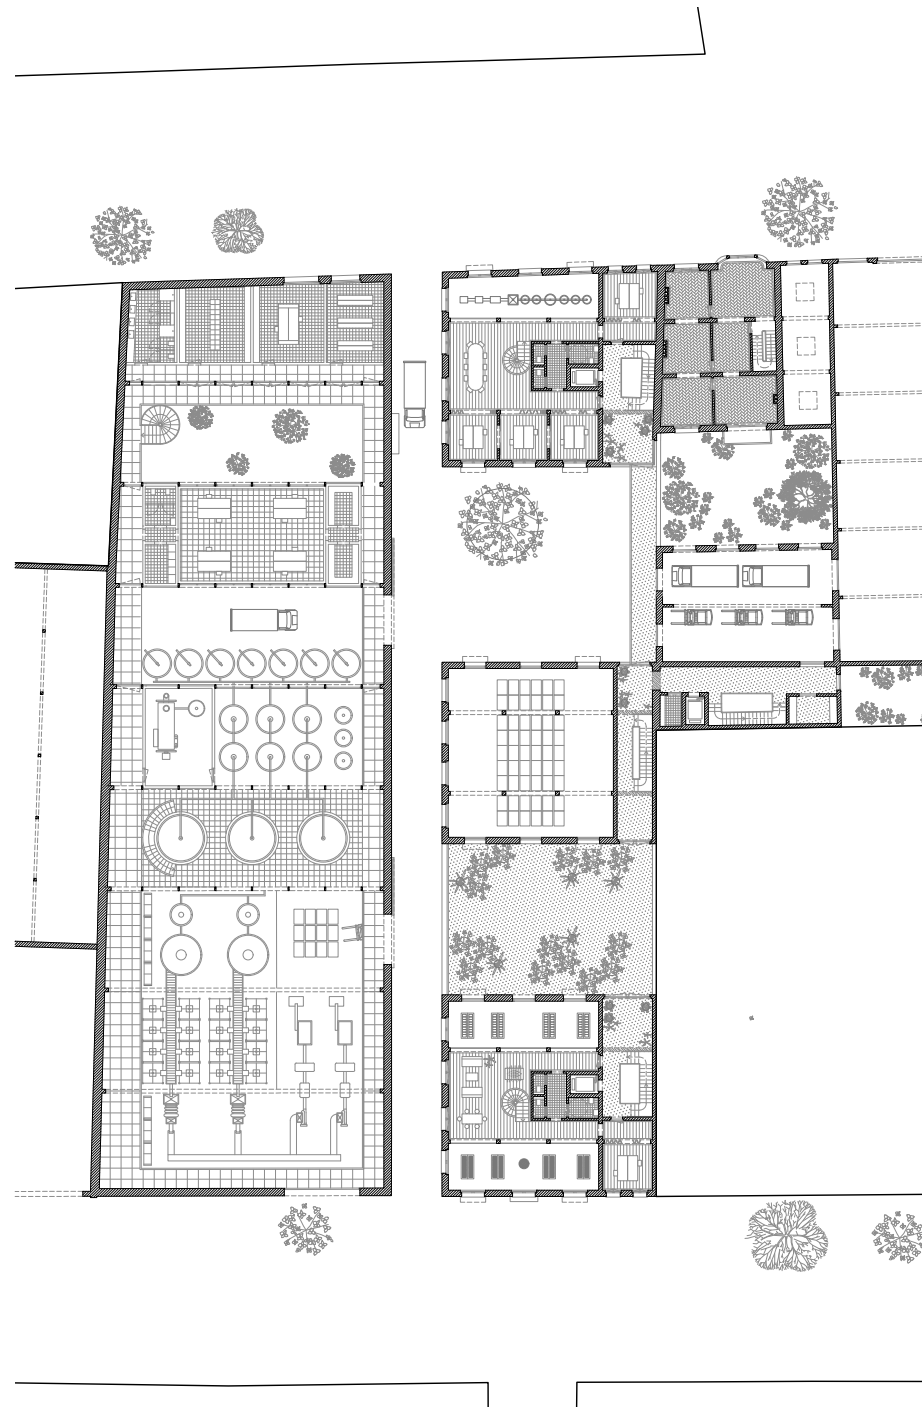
Une nouvelle savonnerie à Bruxelles (plan du 1^{er} étage)
